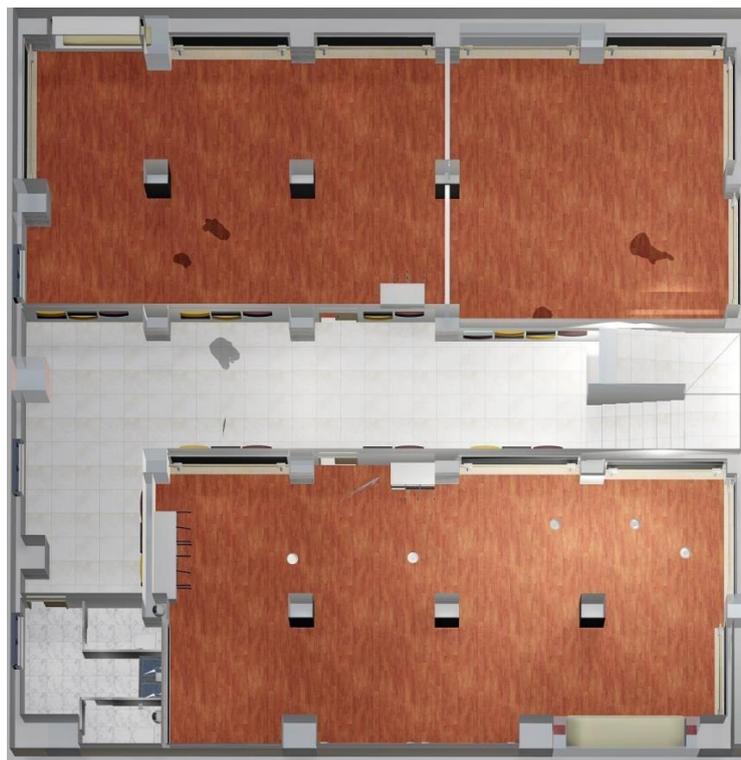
Propuesta de diseño en zona Privada en la Planta Alta.
